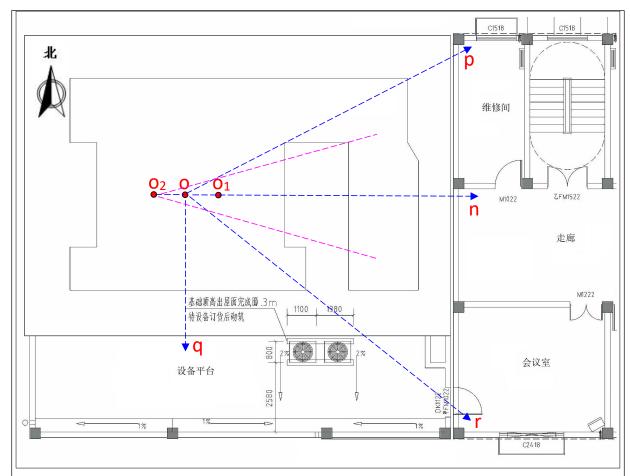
本项目直线加速器周围关注点位置平面图(放疗中心二层)
